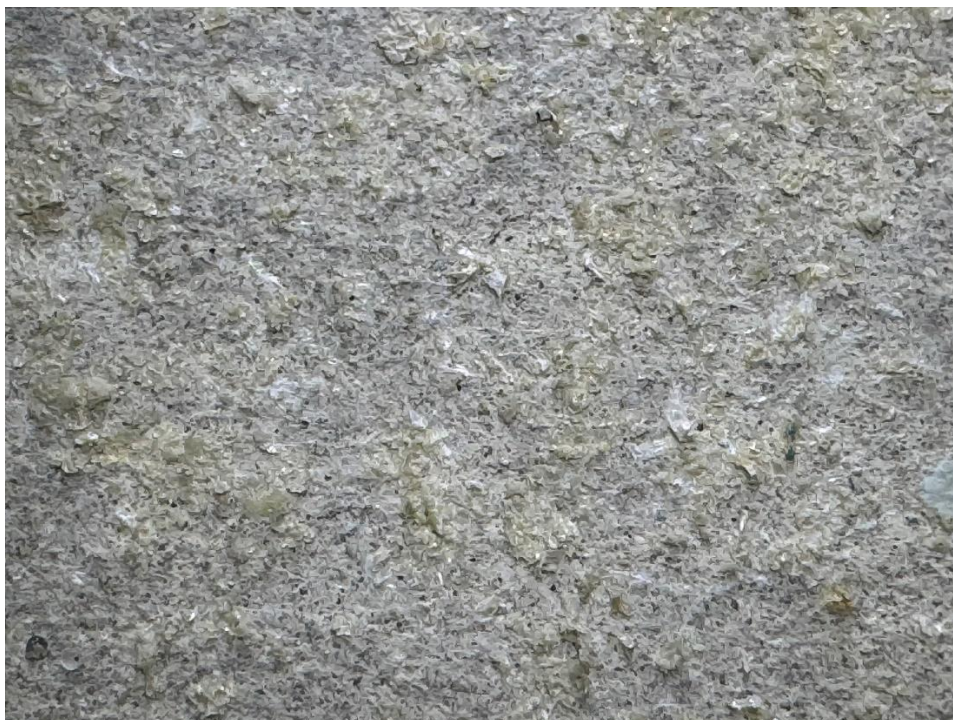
Test panel med opløsning 1:3. Der sidder noget asbest forseglar tilbage, men det hæfter ikke til overfladen.
